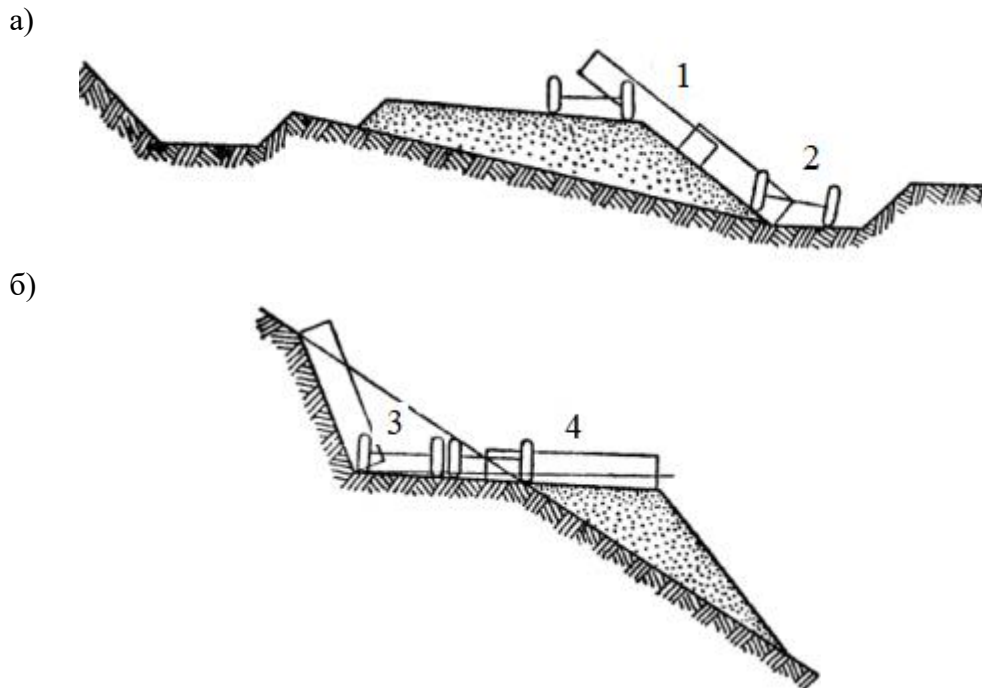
Схемы работы грейдера: а – профилирование откоса, насыпи; б – срезка уступа на косогоре
